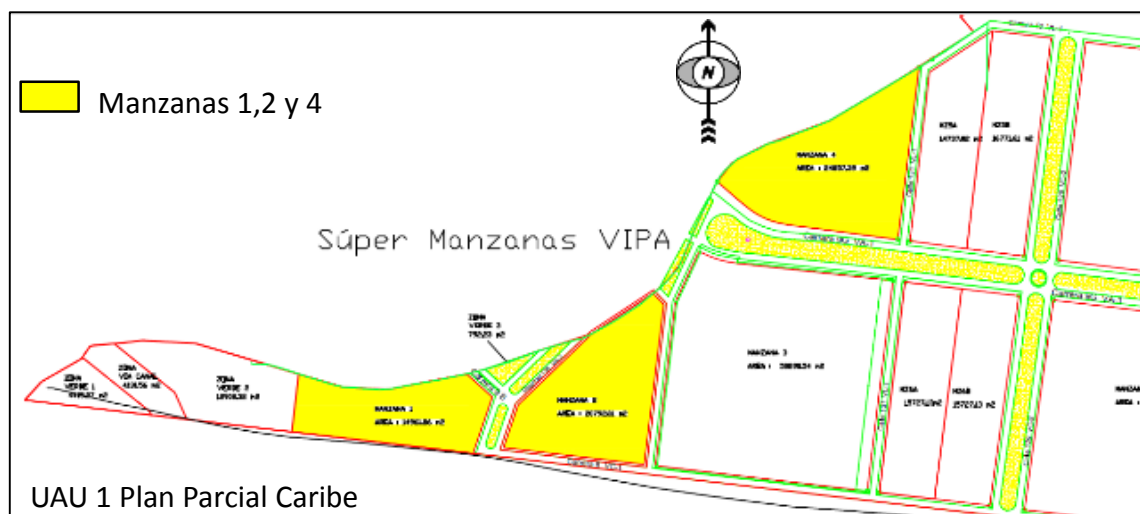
Plano Plan Parcial Caribe Verde.
